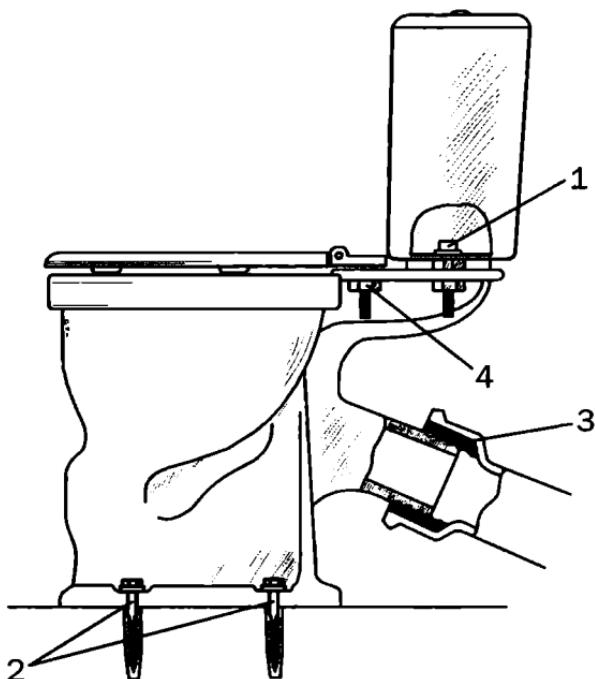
Установка унитаза: 1 — крепеж бачка;
